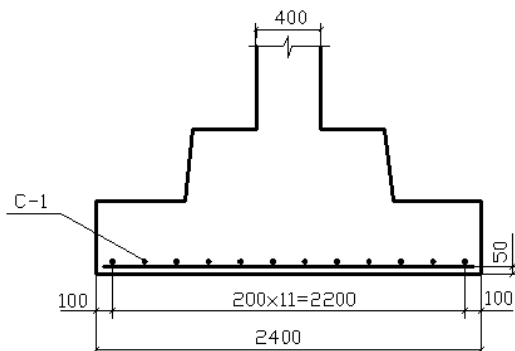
Размещение арматуры фундамента в размере a_f
